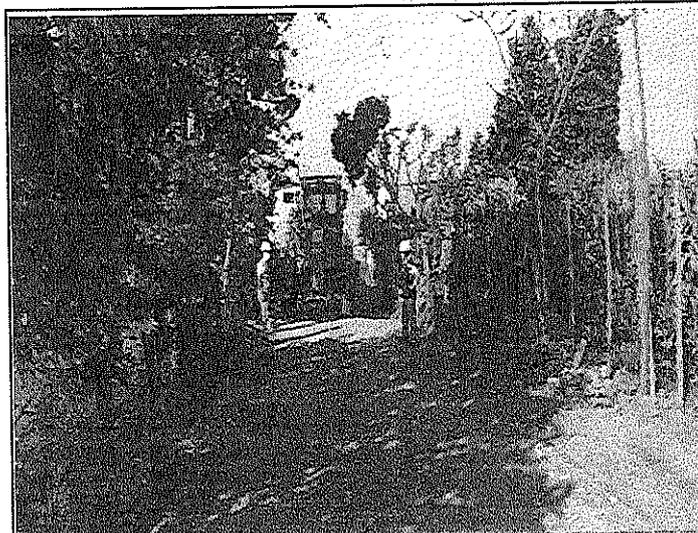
PERFILADO Y ANCHEO DE LAS PARTES MAS ESTRECHAS
